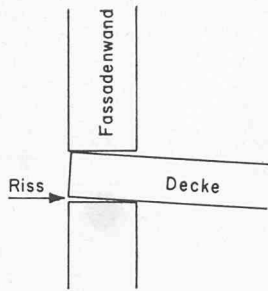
(links). Weiter gespannte Stahlbetondecken mit kleiner Erdbelastung zeigen auf der Fassade wegen der grösseren Durchbiegung horizontale Risse
